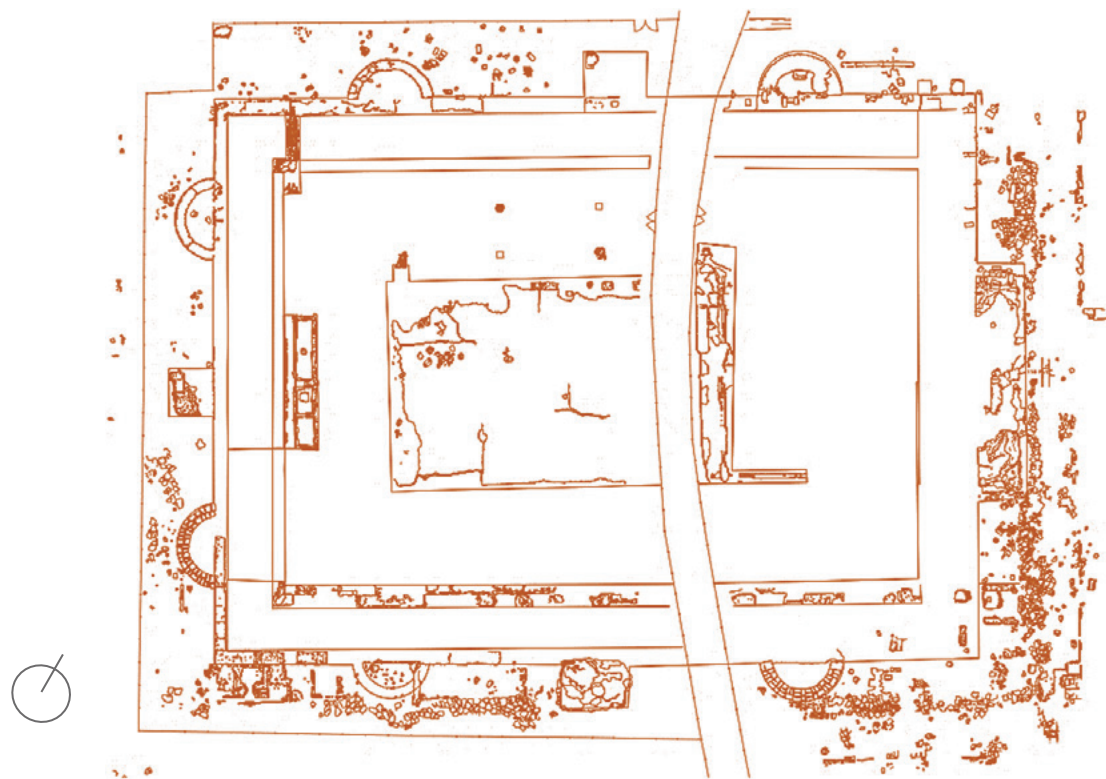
Plano del estado actual del Traianeum (fuente: R. Angulo, 2009. *Elaboración de las fichas diagnóstico de los bienes inmuebles del CAI*)
